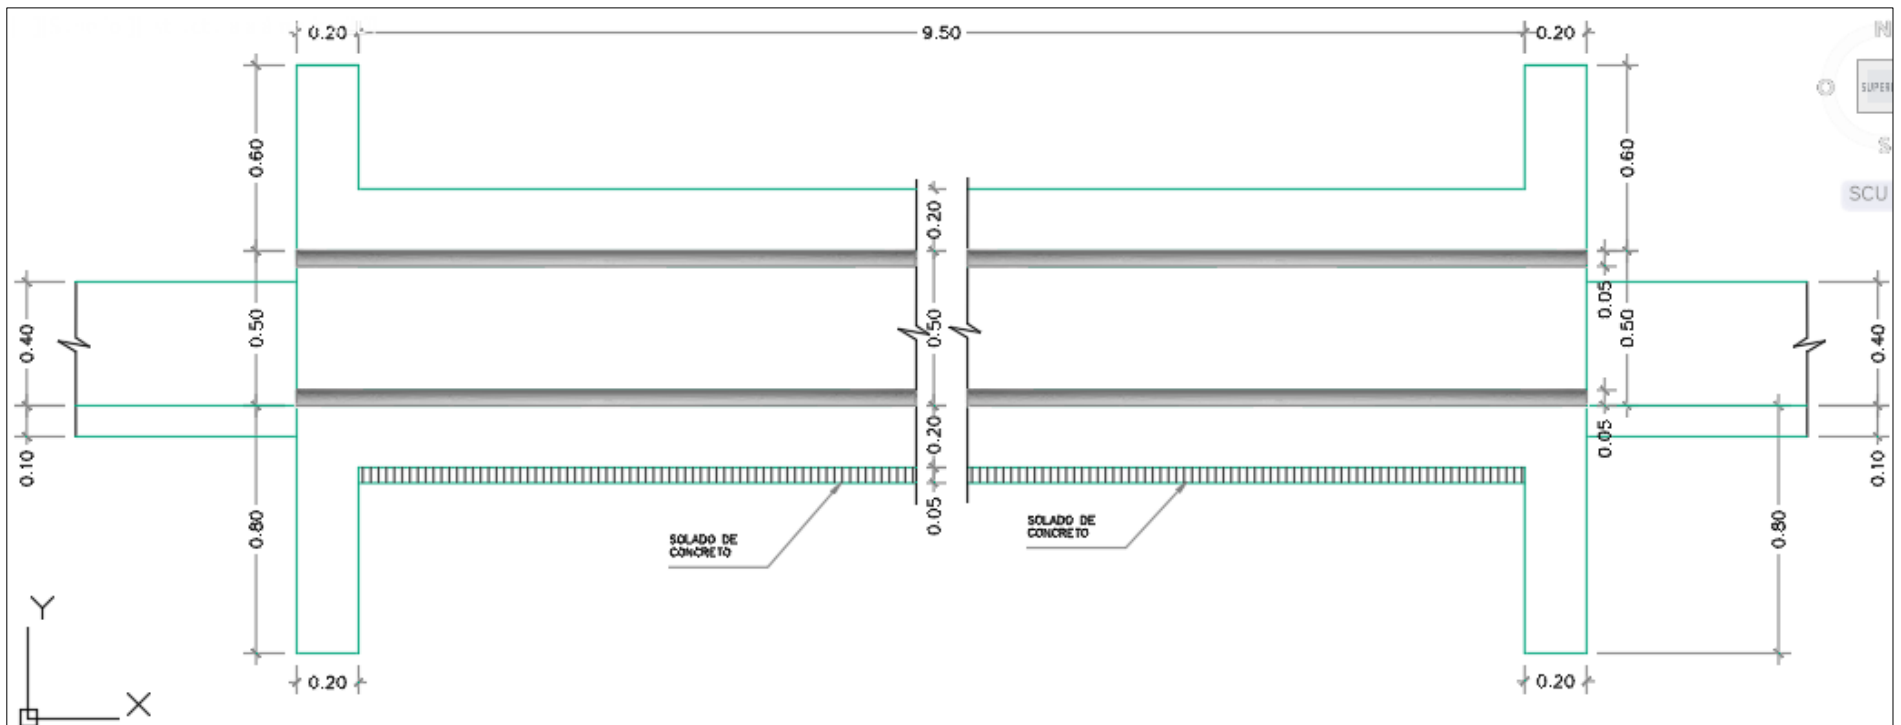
Sección longitudinal de la alcantarilla tipo cajón
